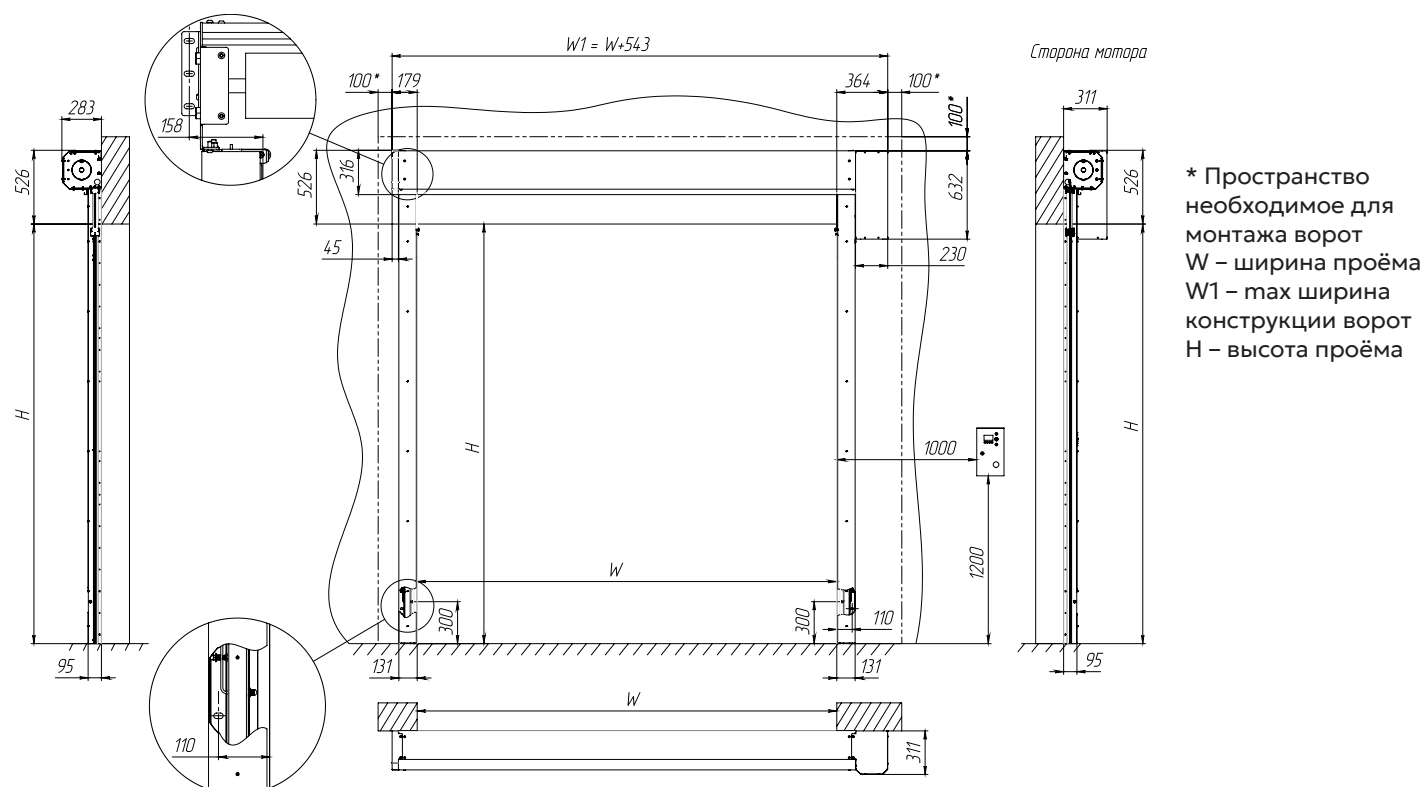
Установочные размеры скоростных ворот Rotor Zip Pro с защитными коробами
